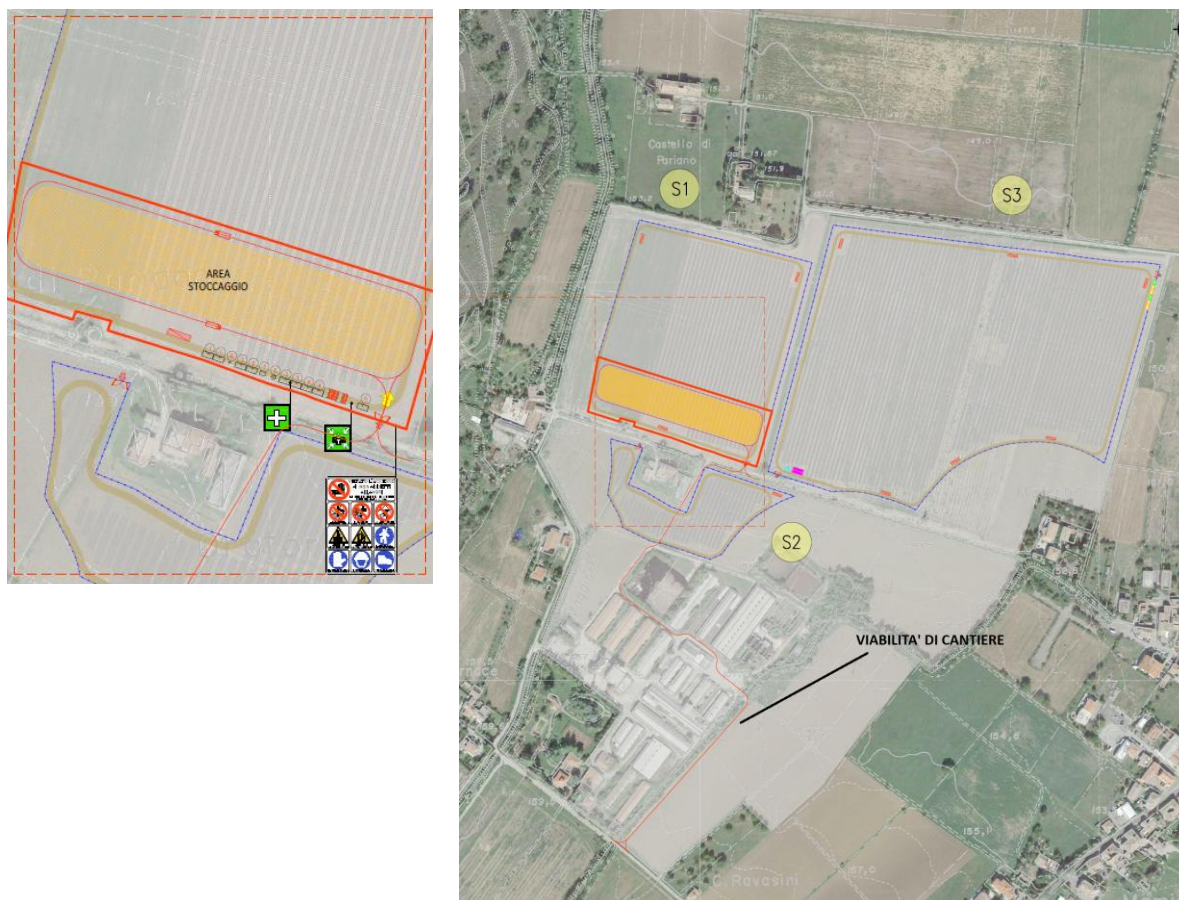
Stralcio delle aree di stoccaggio di cantiere.
